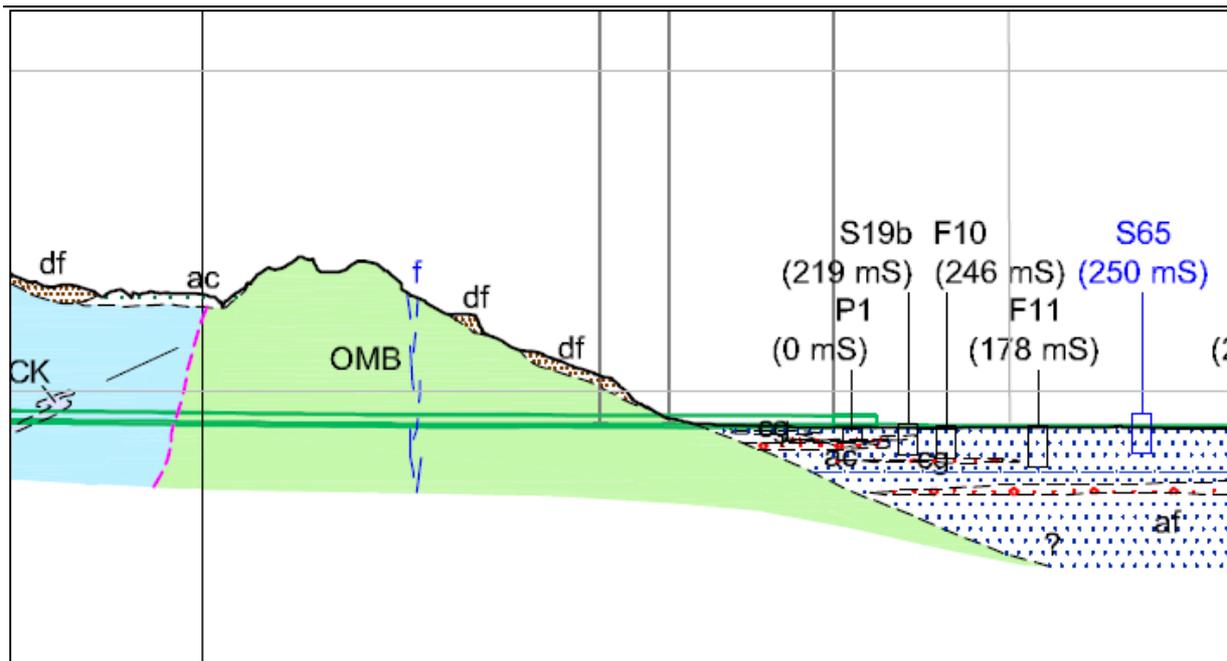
Stralcio del profilo geologico in asse Tunnel di Base nella zona dell'imbocco est del Tunnel di Base (rif. PRVC3BTS30006).
